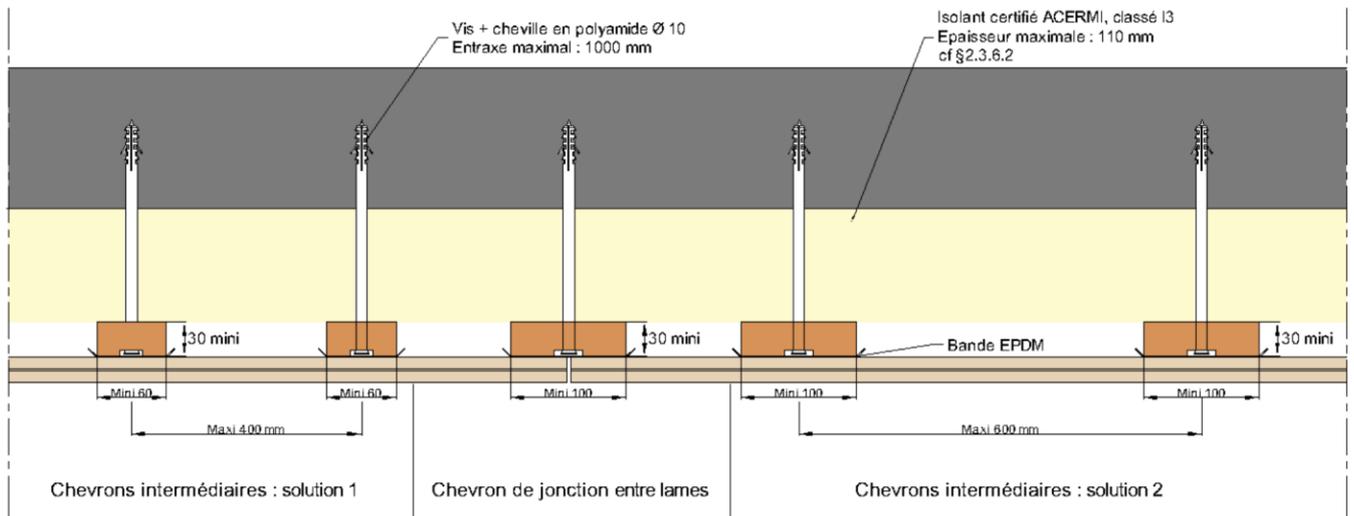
Pose horizontale des lames CEDRAL LAP en vêtage – coupe horizontale
